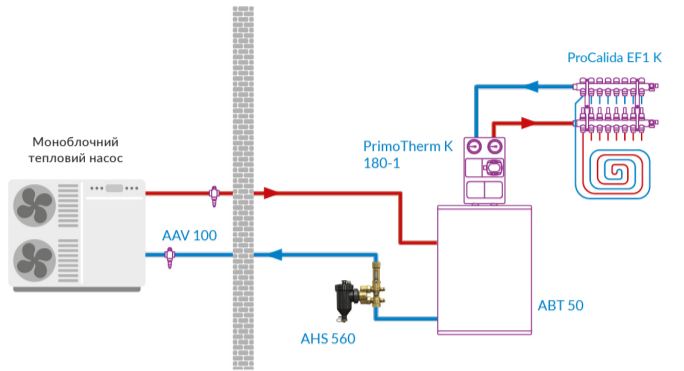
Приклад схеми монтажу з комплектом сервісної арматури для теплових насосів AHS 560
